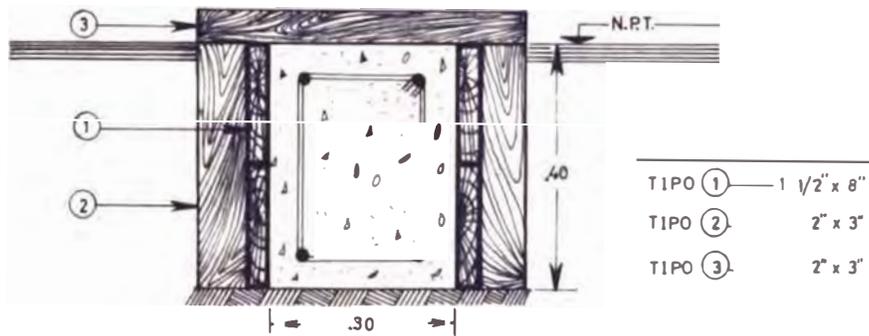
ENCOFRADO DE VIGA DE CIMENT. DE MURO NO PORTANTE
